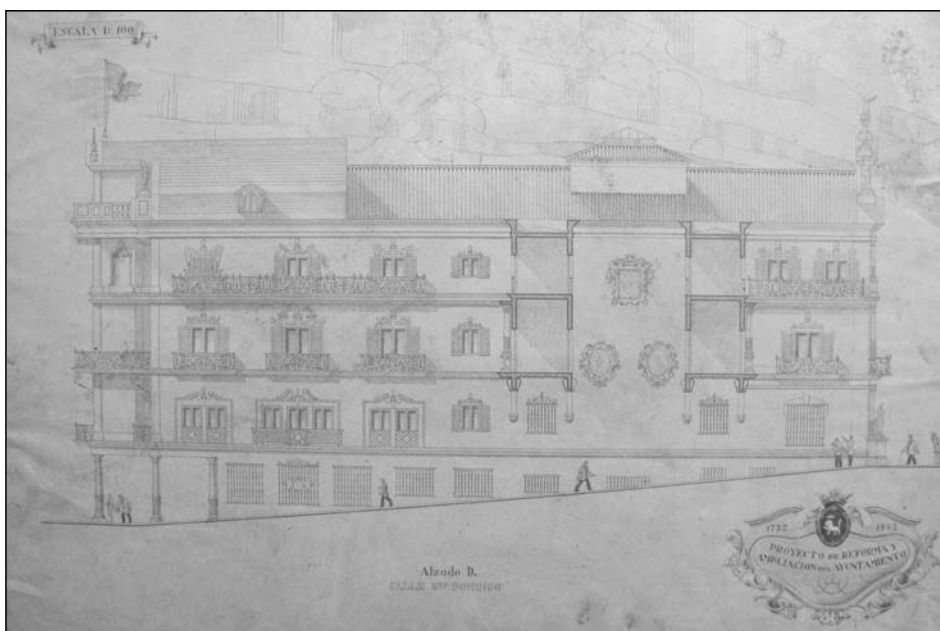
Proyecto de reforma y ampliación del Ayuntamiento. Eugenio Arraiza. Alzado D. Fachada lateral a la calle Santo Domingo. AMP
